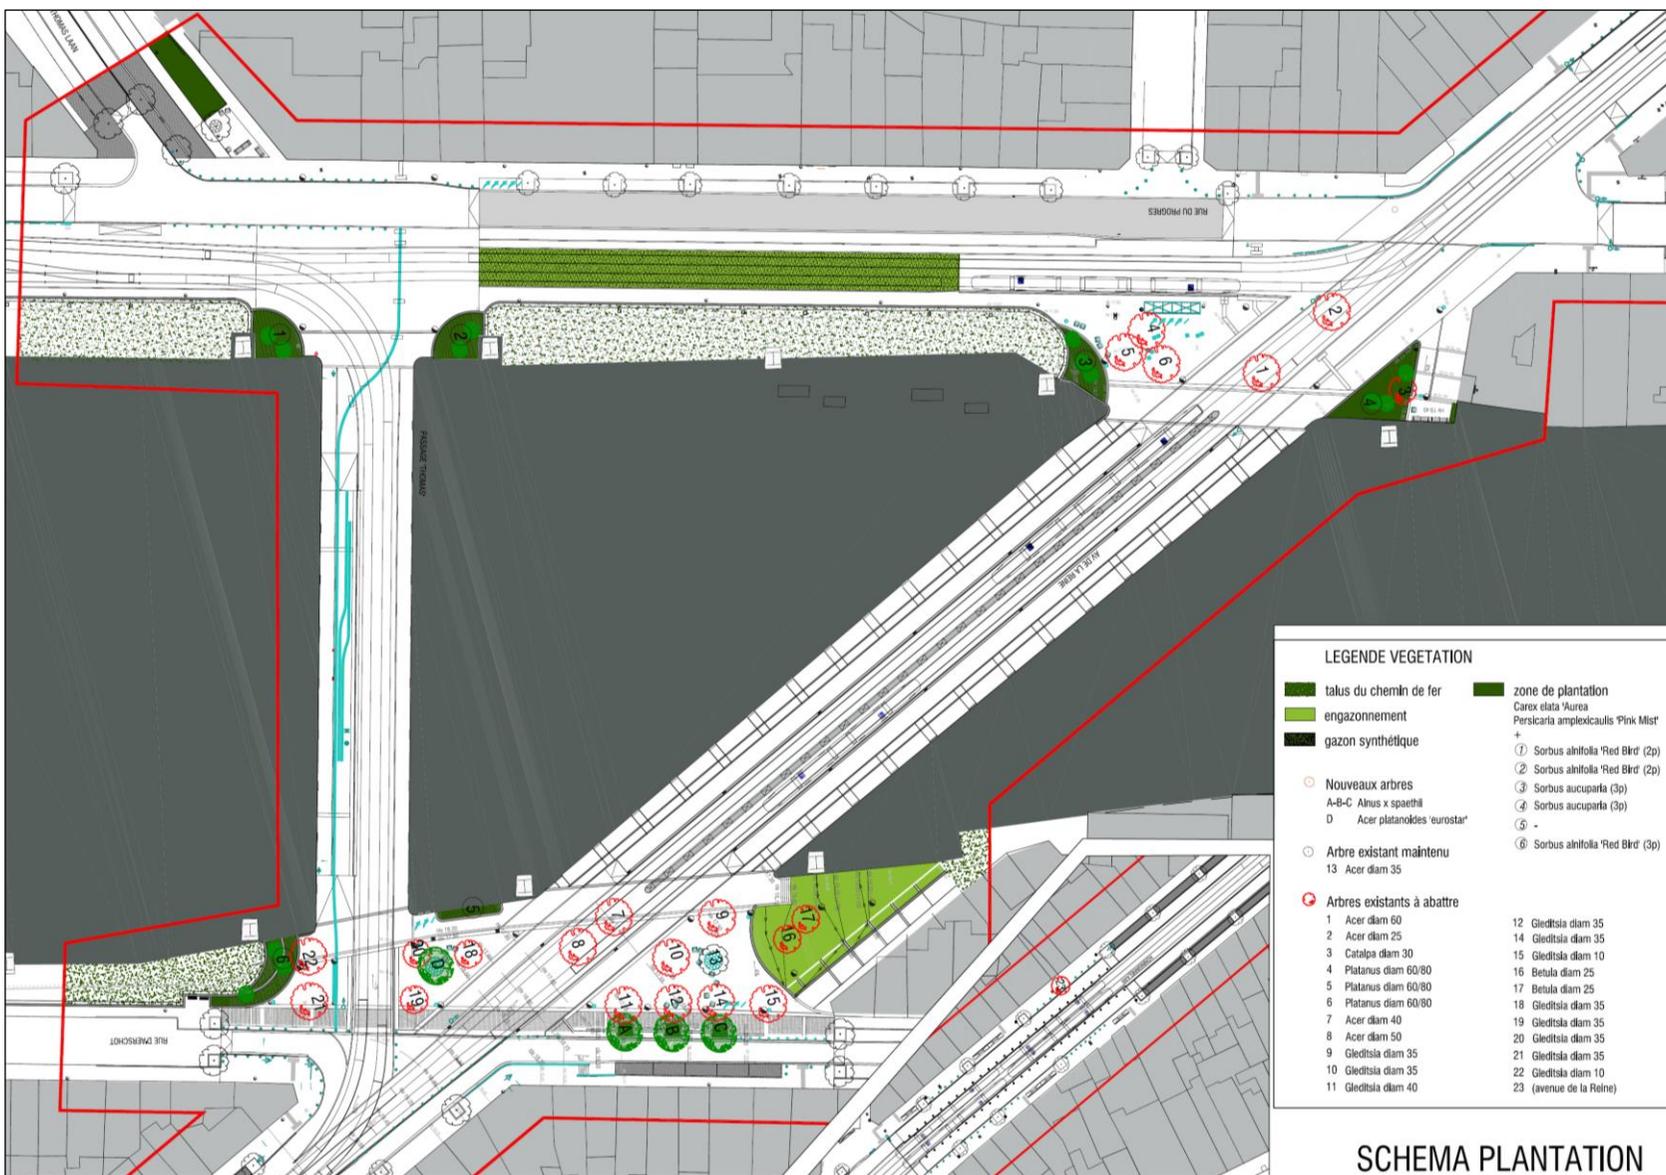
Schéma des plantations (Source : Dessin et Construction)
